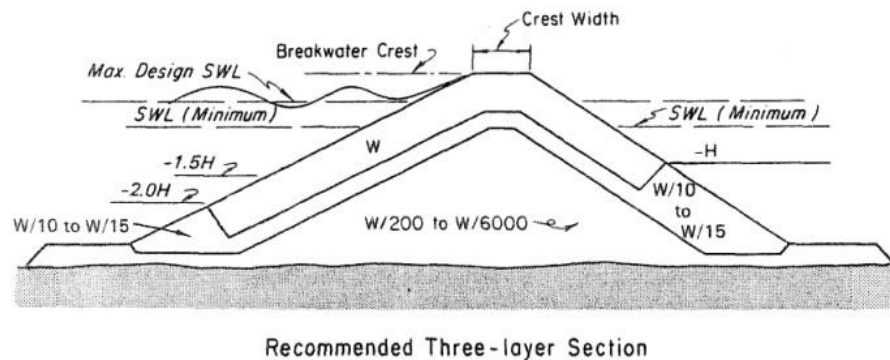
IMAGEN II. SECCIÓN DE DIQUE DE ABRIGO PROPUESTA
